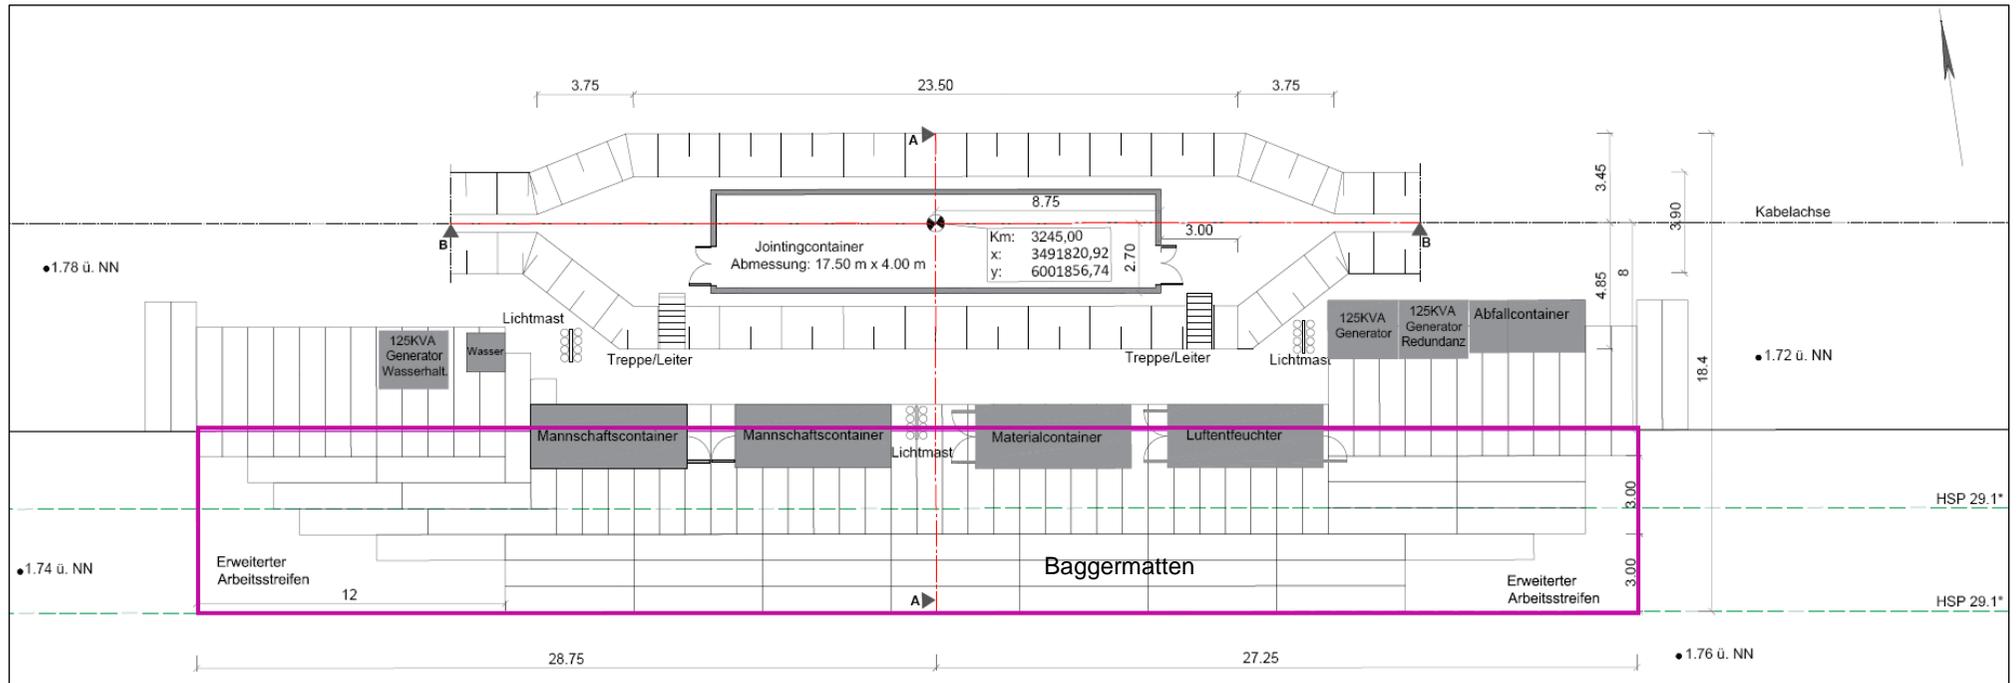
Grundriss BE-Fläche und Baugrube zur Herstellung des Kabelverbindungssystems (Prinzipiskizze)
